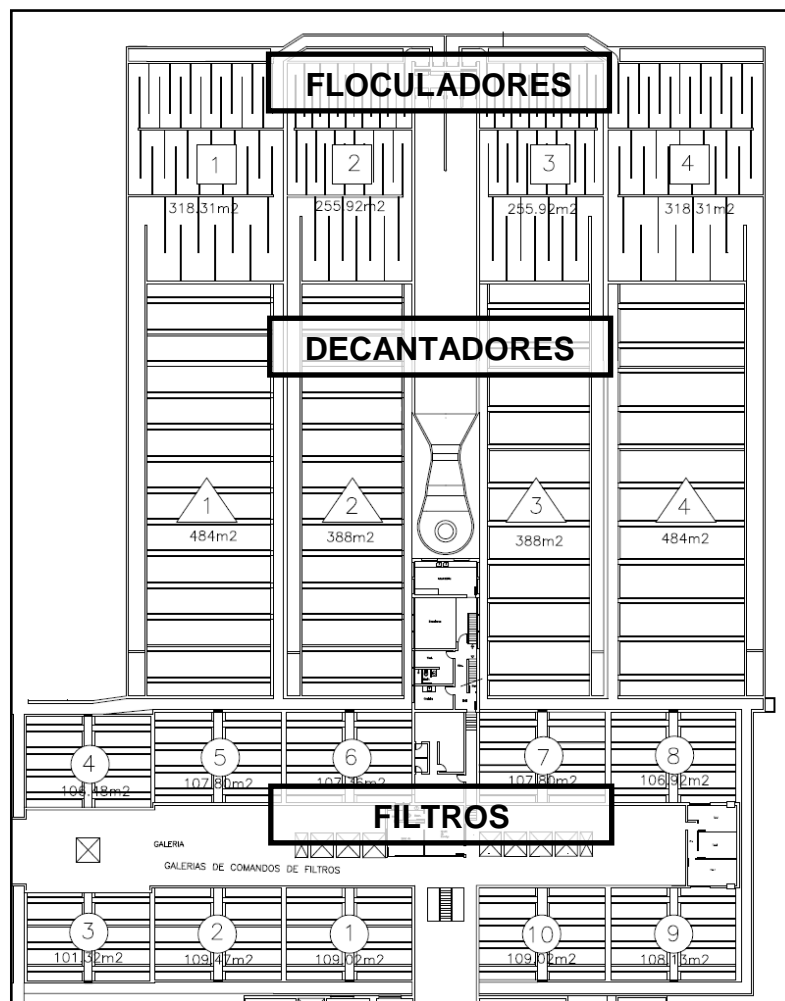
Planta baixa da ETA nº 1 de Laranjal
